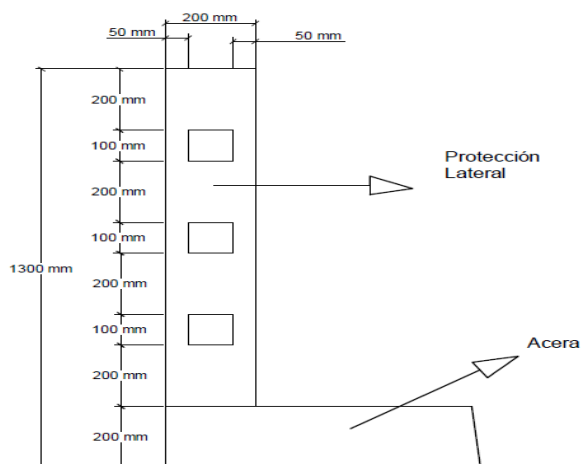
Vista transversal de las protecciones laterales del puente. Elaborado por: El autor
